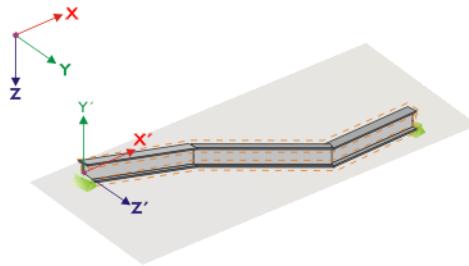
Sistema de coordenadas auxiliar para los apoyos en nudos - conjunto de barras en el plano horizontal
